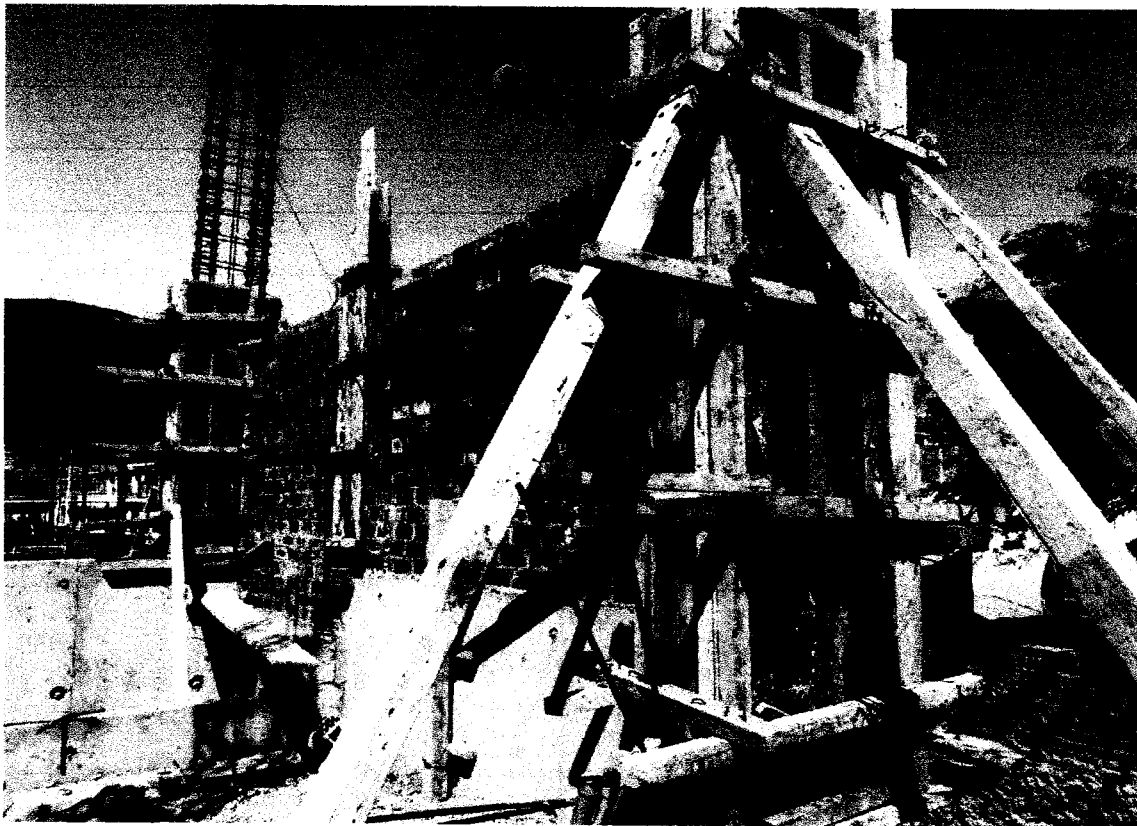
Asentamiento de muros y fundido de placas en sociales.
